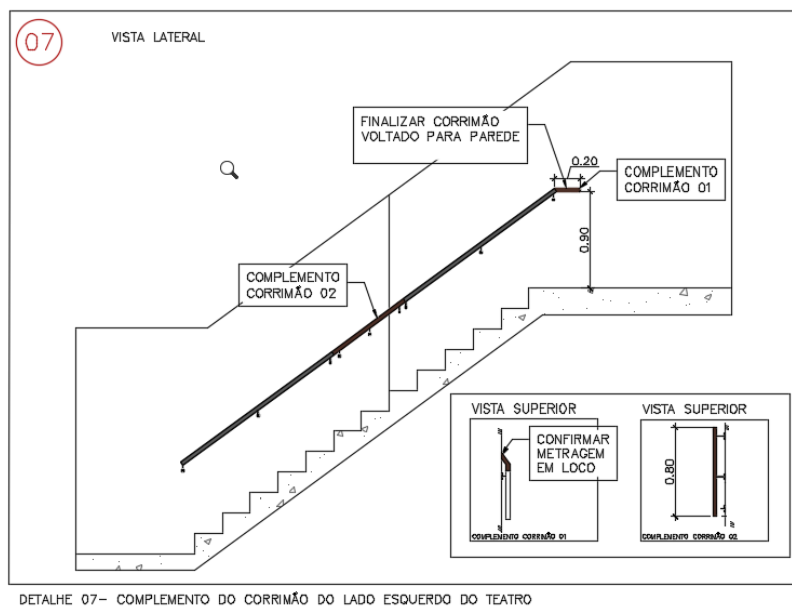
DETALHES DO GUARDA CORPO METÁLICO
